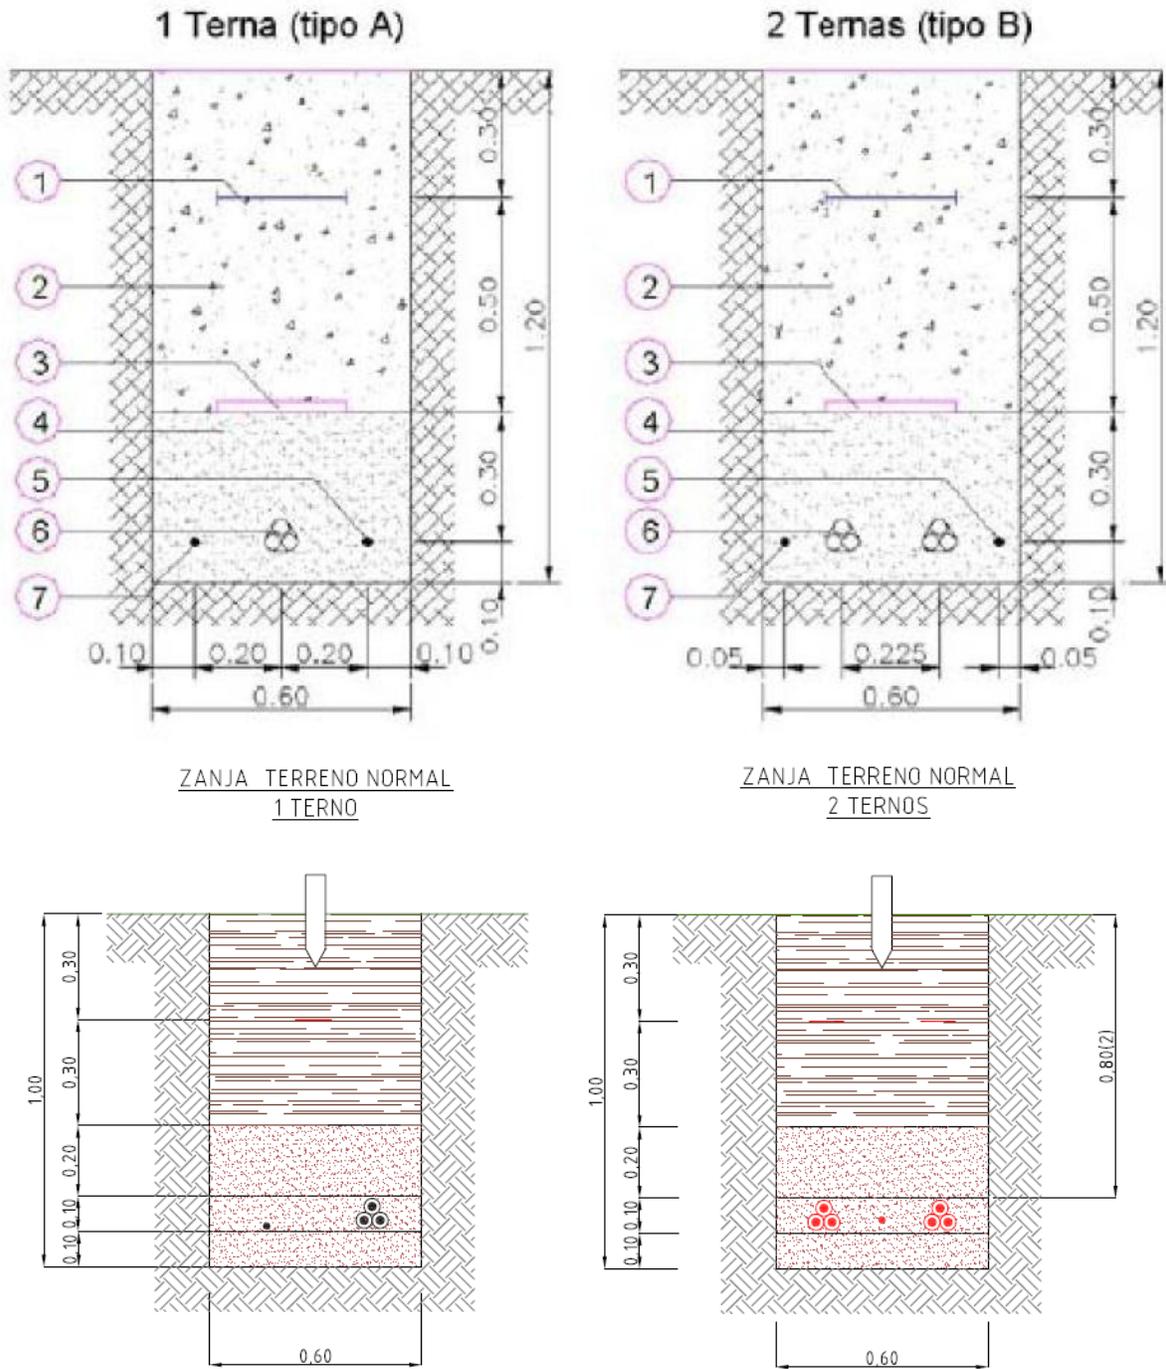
Sección de las zanjas MT que se efectuaran en el predio.
